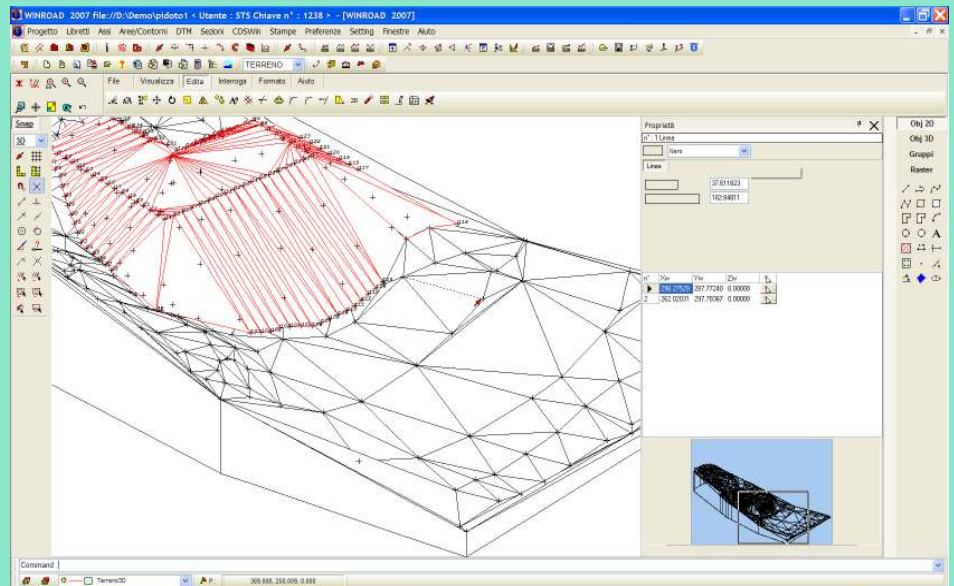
Estrazione delle quote terreno e progetto lungo una sezione da modelli DTM.
